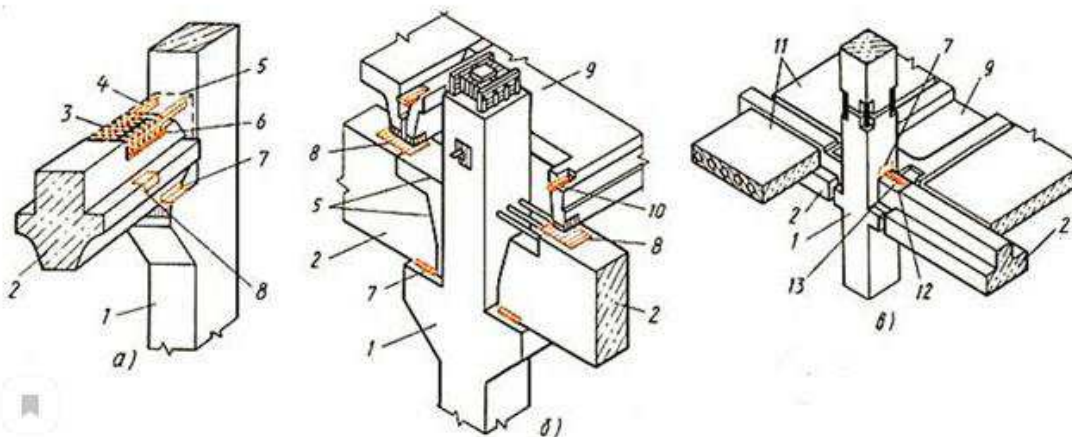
д – Соединения ригеля с колонной в каркасе здания
